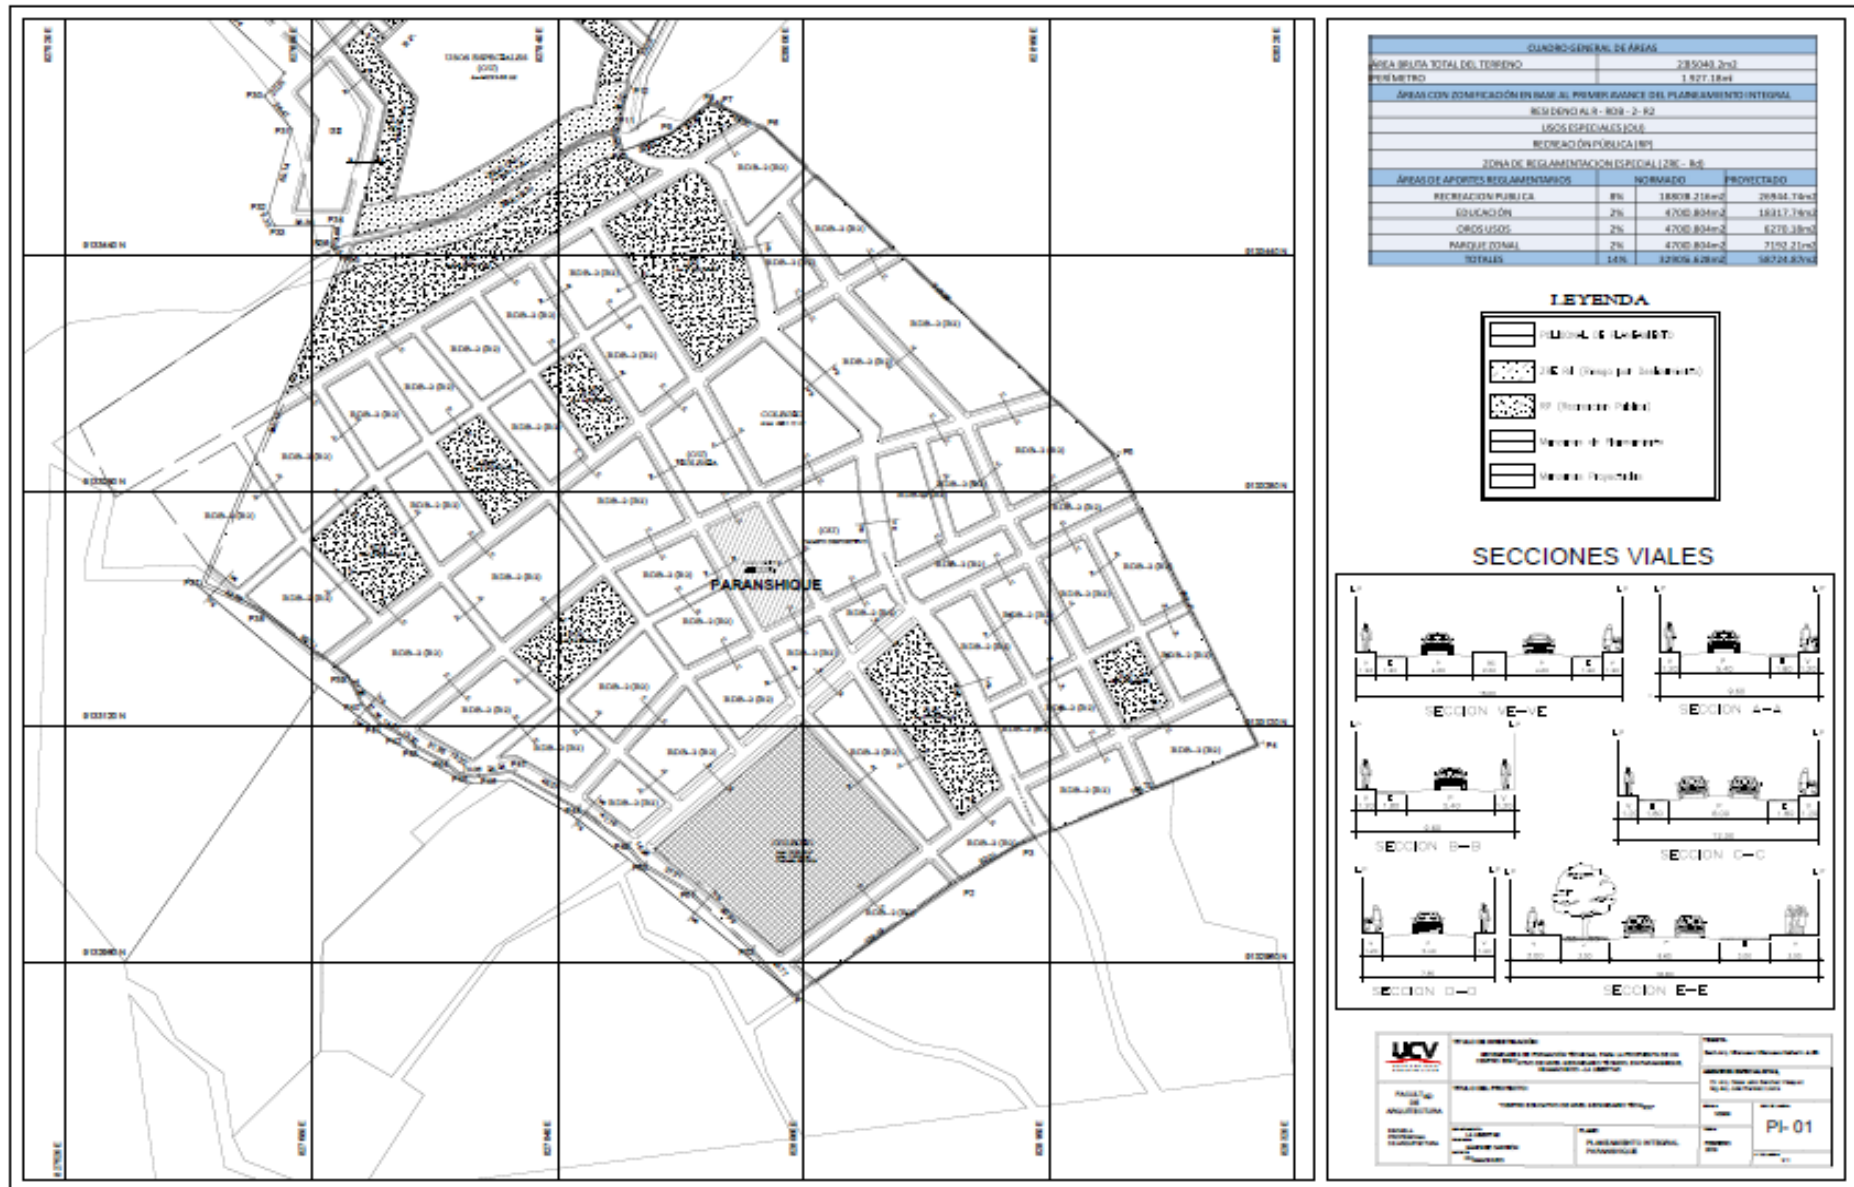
Plano de Planeamiento Integral – Plano N° 04 - Lamina PI-01
